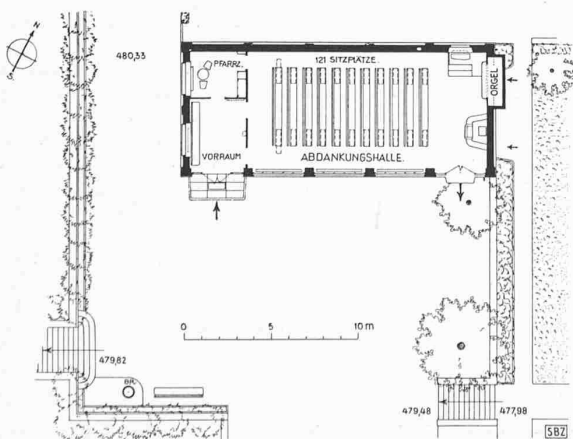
Abdankungshalle, Grundriss 1:400
